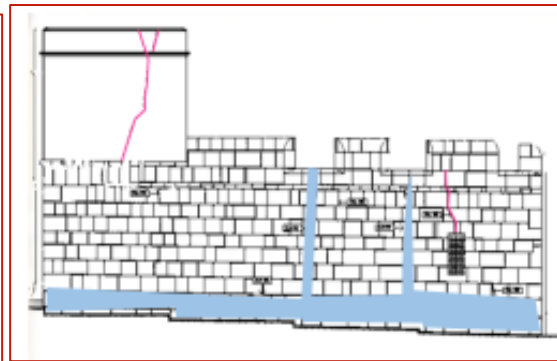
Fissuration au niveau surélévation de la façade est
